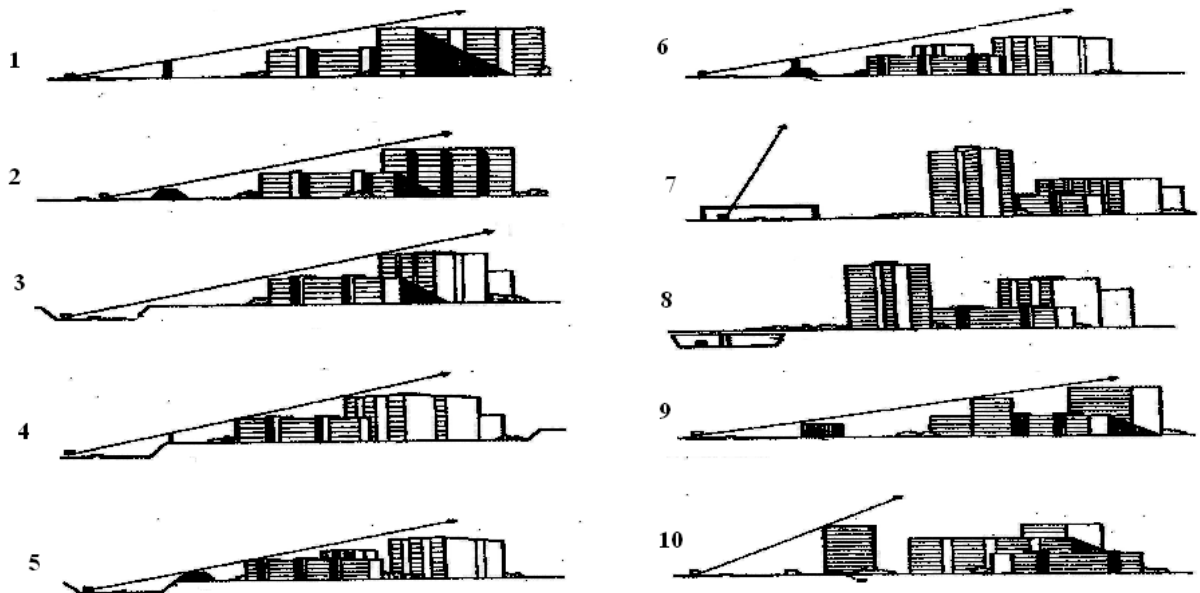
Типи екранів: 1 – стінка; 2 – насип; 3 – виїмка; 4 – тераса; 5, 6 – комбіновані екрани; 5 – виїмка з насипом або стінкою; 6 – насип зі стінкою; 7 – екран-галерея; 8 – екран-тонель; 9 – екран-будинок нежилого призначення; 10 – екран-шумозахисний житловий будинок.
